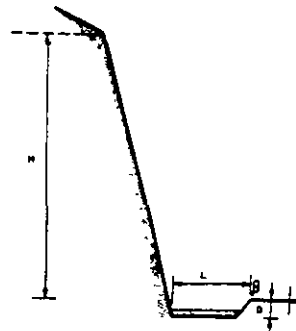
Recomendaciones para el dimensionamiento de zanjas al pie del talud con objeto de proteger la carretera de la caída de piedras.
